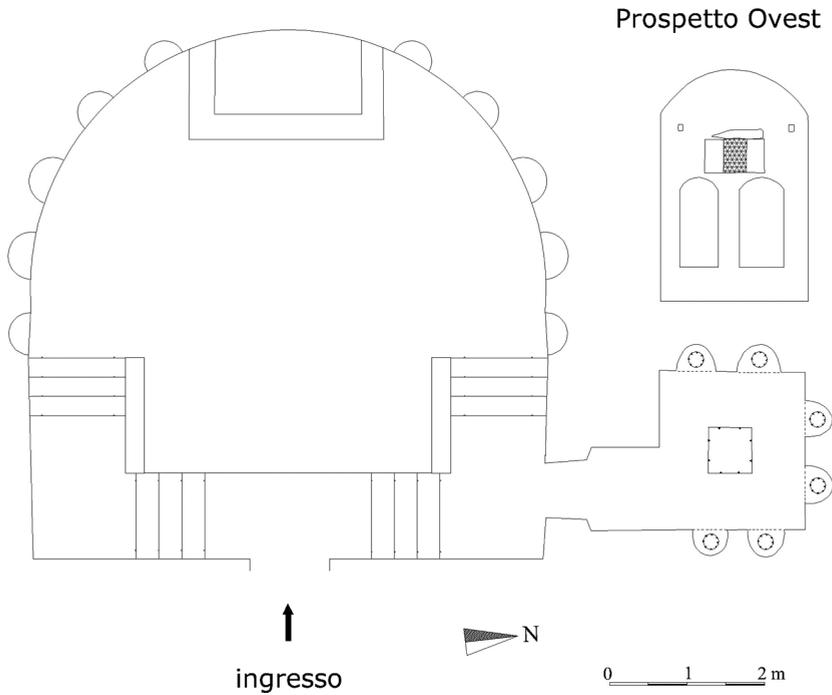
Savoca (ME), cripta della Chiesa Madre, planimetria e prospetto ovest del vano settentrionale
